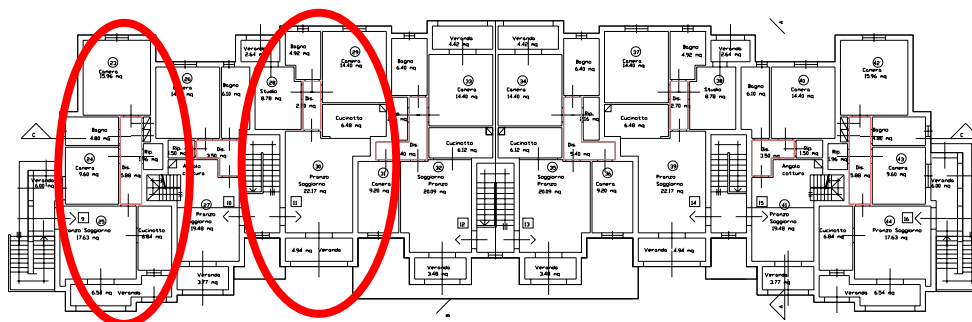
Esempio di edificio in linea rappresentato in pianta ad un piano tipo; si nota un giunto di separazione strutturale a metà dell’estensione: si seleziona un ambiente di testata ed uno intermedio non in corrispondenza del giunto di separazione strutturale.
